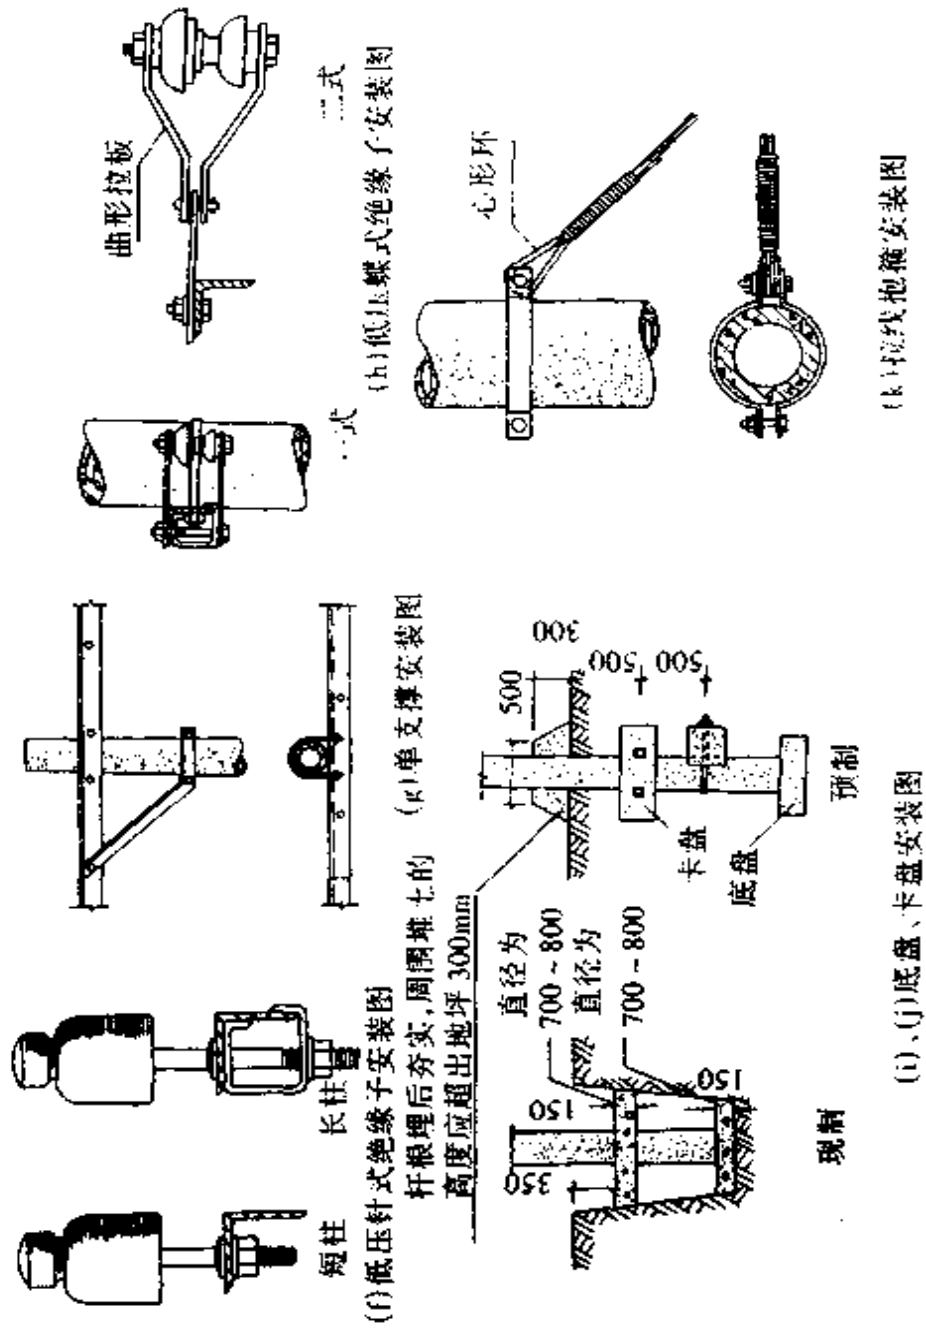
钢筋混凝土电杆各种附件安装图(二)
